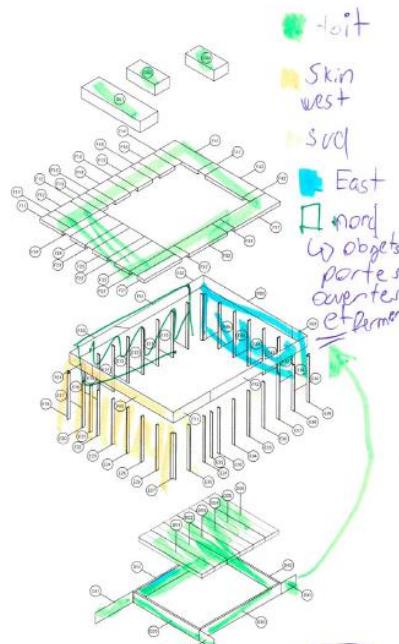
Regroupement pour la 3D du bâtiment traitant les façades et le toit
